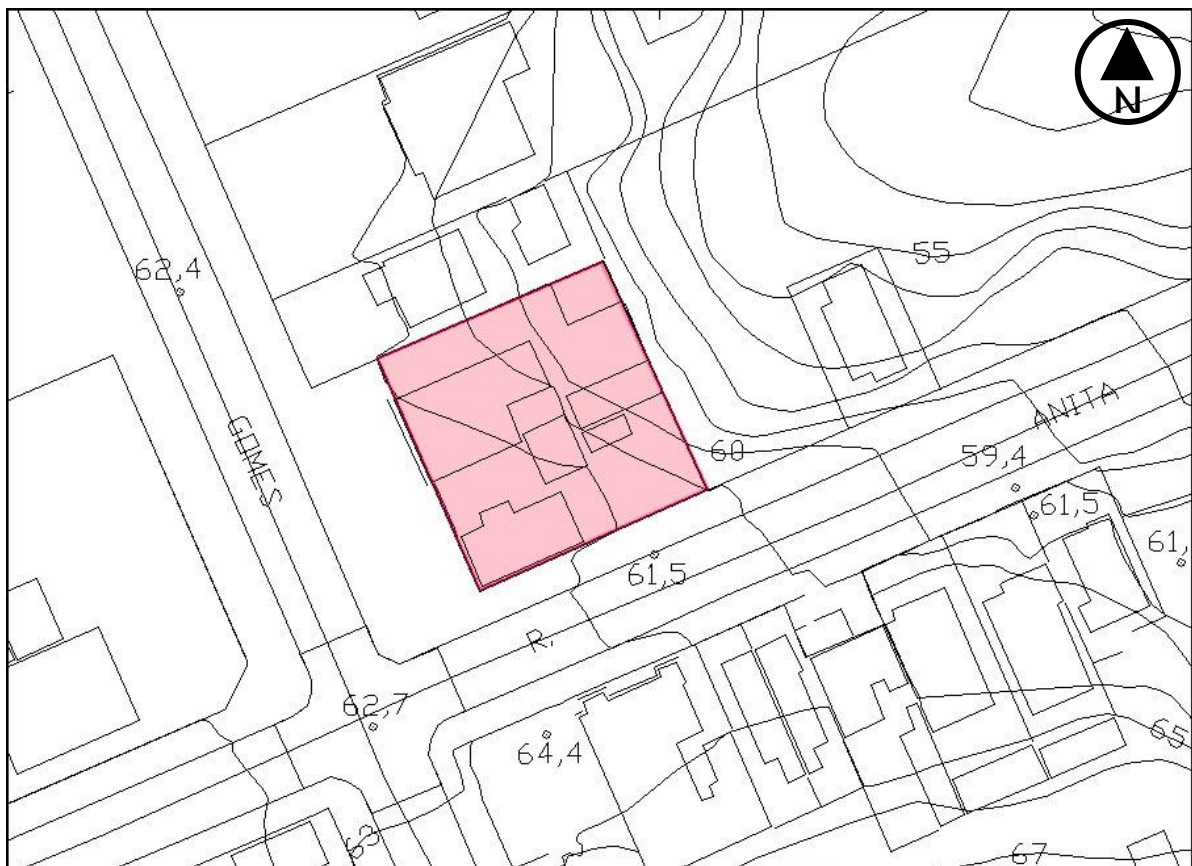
Levantamento Planialtimétrico da região em estudo.
